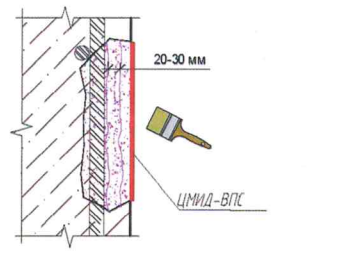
Ремонт участков с поверхностными дефектами бетона глубиной от 1 до 5 см и площадью до 1 м² без обнажения арматуры.
